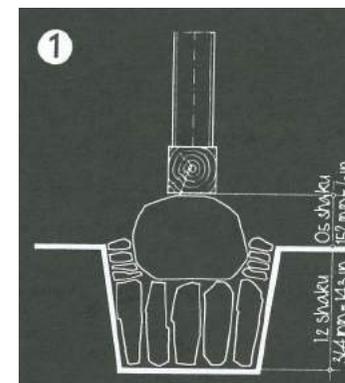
'tamaishi-kiso', Rundsteinfundament, übliche Grundlage für das Grundgerüst
